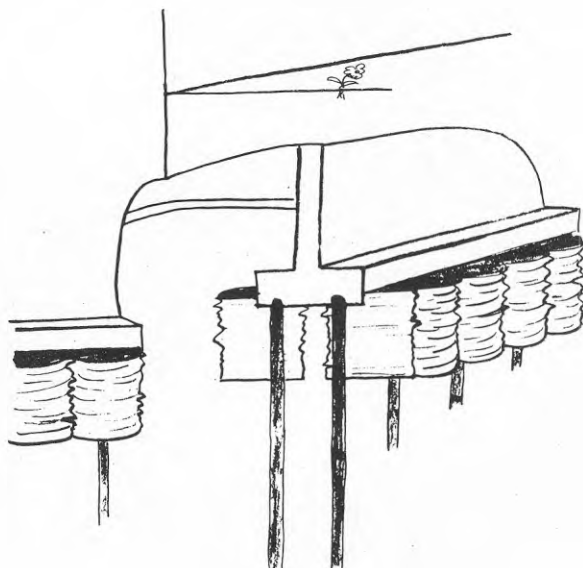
Grundförstärkning av ett relativt modernt bostadshus med betongstomme grundlagt på träpålar. Lasten från byggnaden förs via den injekterade jorden ner till friskt pålvirke under grundvattenytan.
